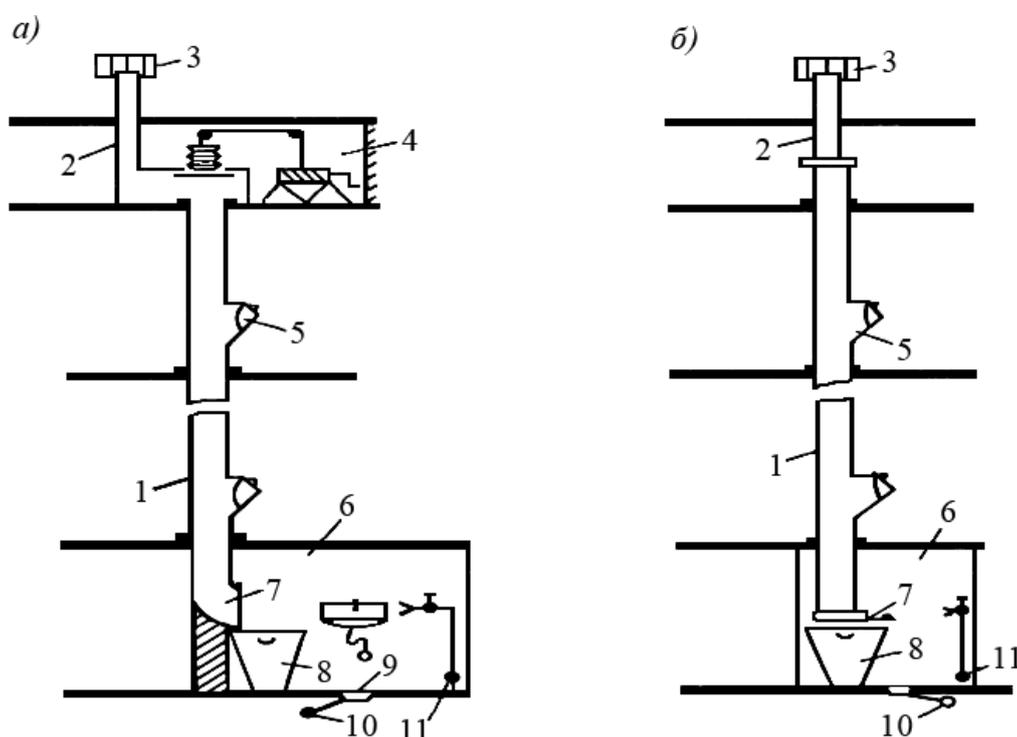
Схема холодных сухих трубопроводов: *а* – с верхней и нижней камерами (полная схема); *б* – то же, упрощенная схема; 1 – ствол (шахта); 2 – вентиляционная труба; 3 – дефлектор; 4 – верхняя камера; 5 – приемный кран; 6 – нижняя камера; 7 – бункер с шибером; 8 – мусоросборник; 9 – трап; 10 – канализация; 11 – холодный и горячий водопровод
